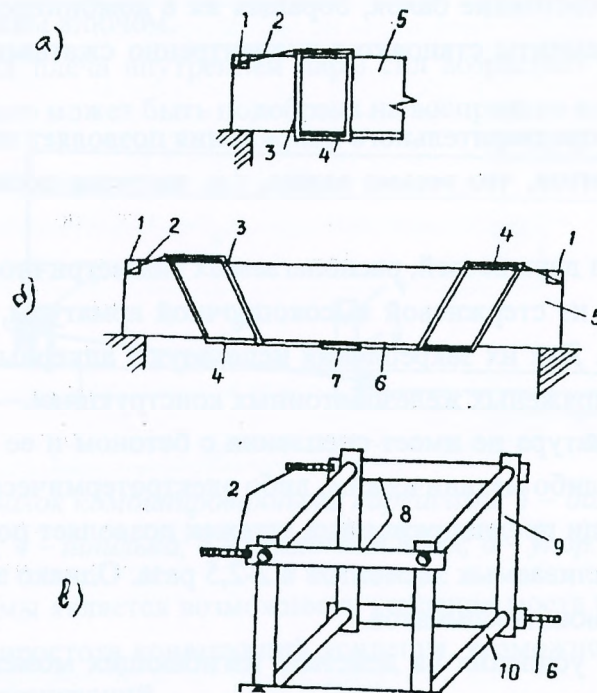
Усиление балки наклонными хомутами: а) и б) – устройство и конструкция до и после создания предварительного напряжения; в) – общий вид. 1 – закладные
